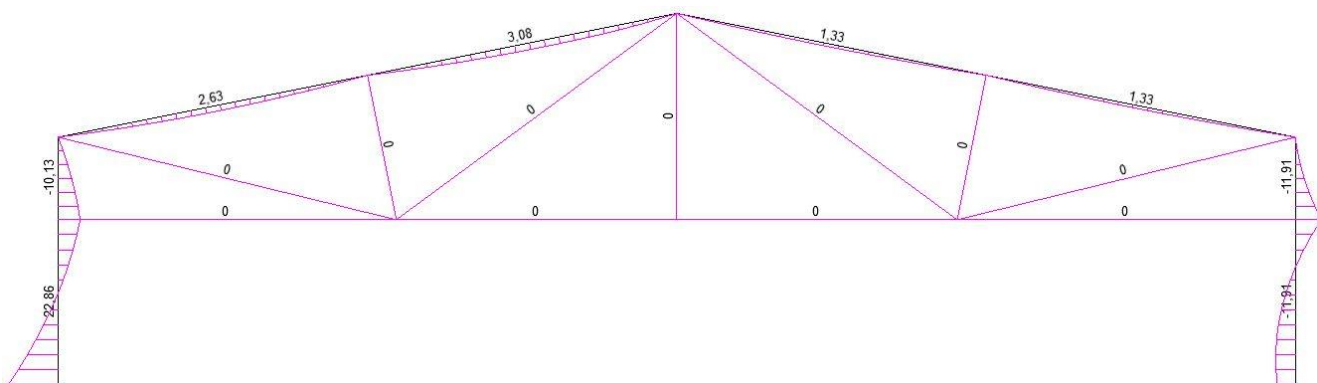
Ветровая нагрузка, 2 вариант, эпюра М
